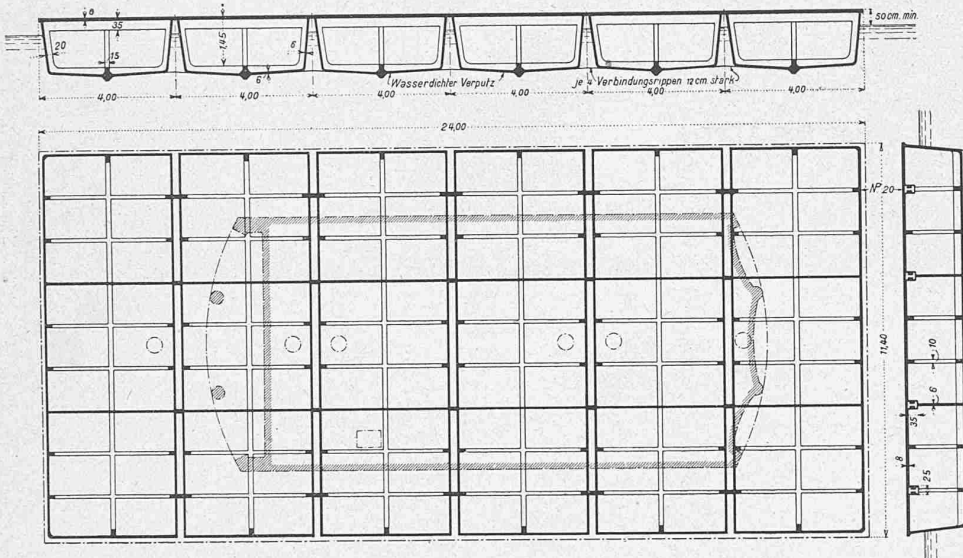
Grundriss, Längs- und Querschnitt des Eisenbeton-Flosses. — Masstab 1:200.
